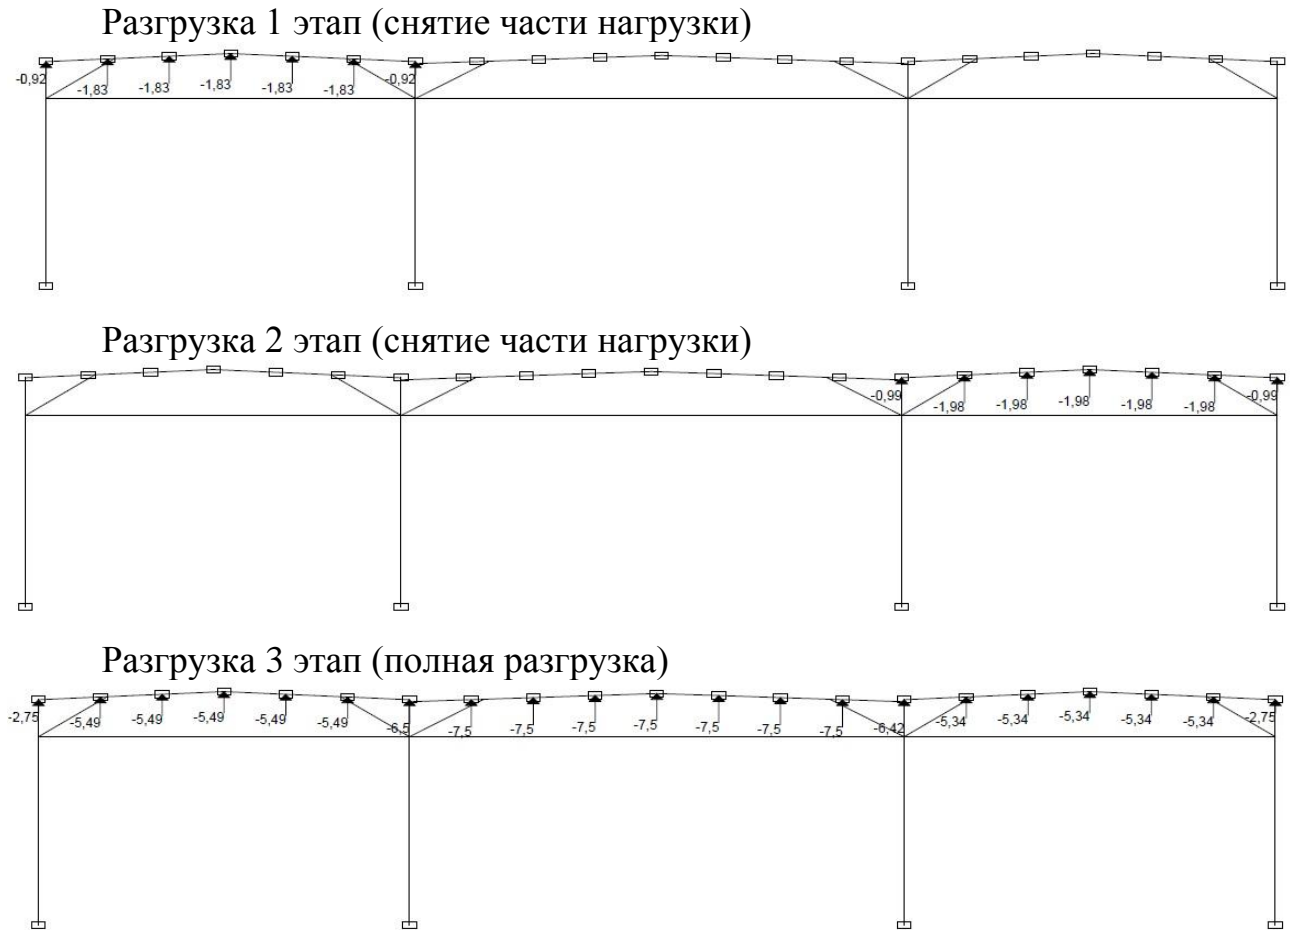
Ступени разгрузки конструкций в ходе испытаний
